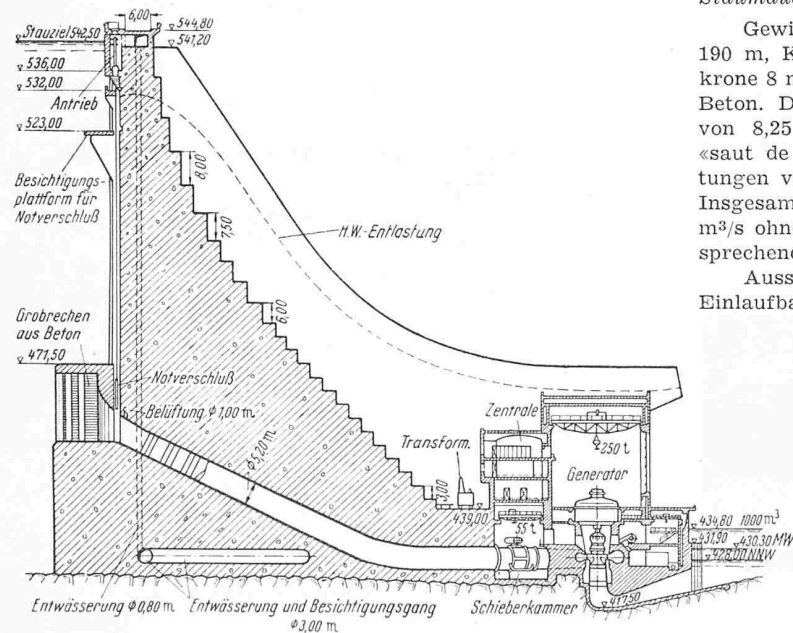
Kraftwerk Bort. Schnitt 1 : 1600 durch Staumauer und Zentrale (Cliché «Der Bauingenieur»)
